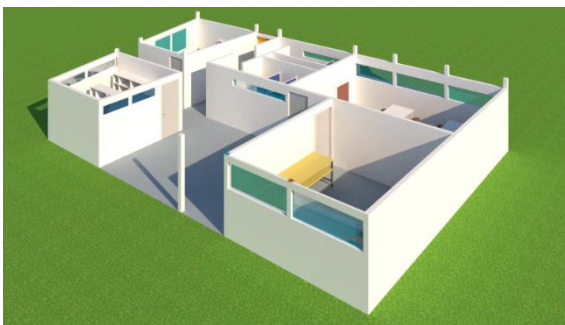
Modelo Talleres de autoconstrucción. (Elaboración propia)
